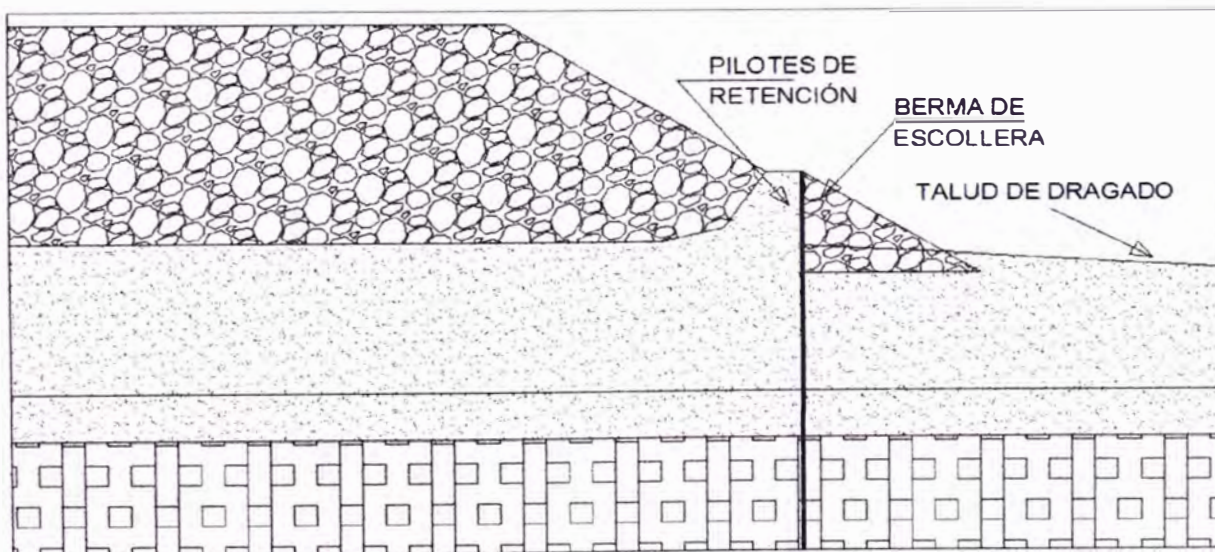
Esquema de pilotes y escollera de apoyo
